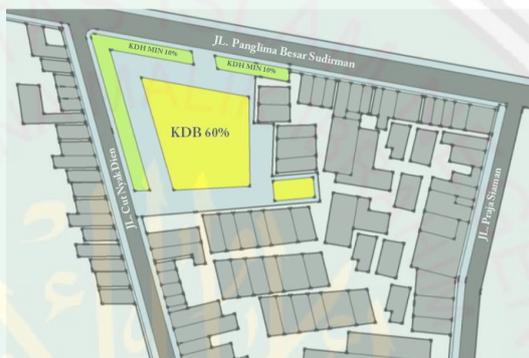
Buble dan Block Plan Pasar Lantai 2
